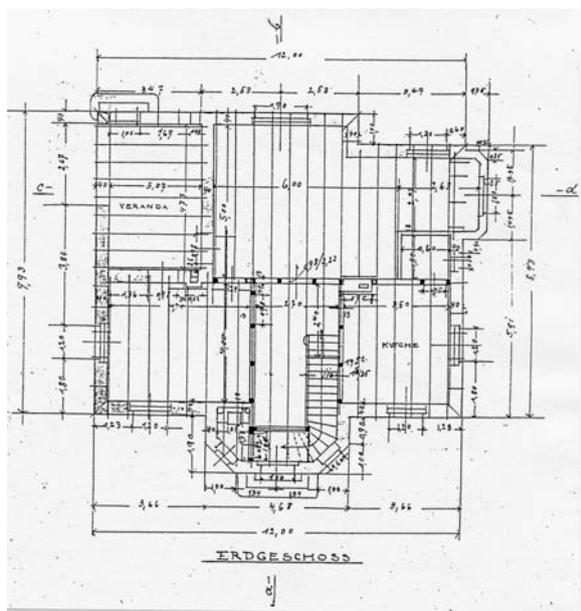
Sommerhaus H. Plange, Grundriss Erdgeschoss, 1898
